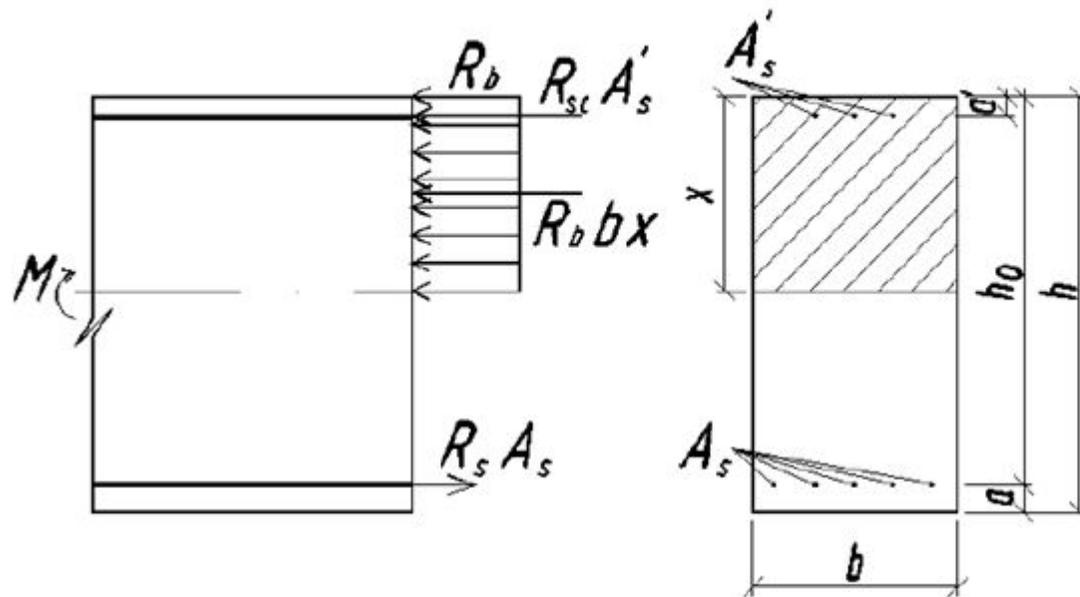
Расчетная схема изгибаемых элементов с двойной арматурой
